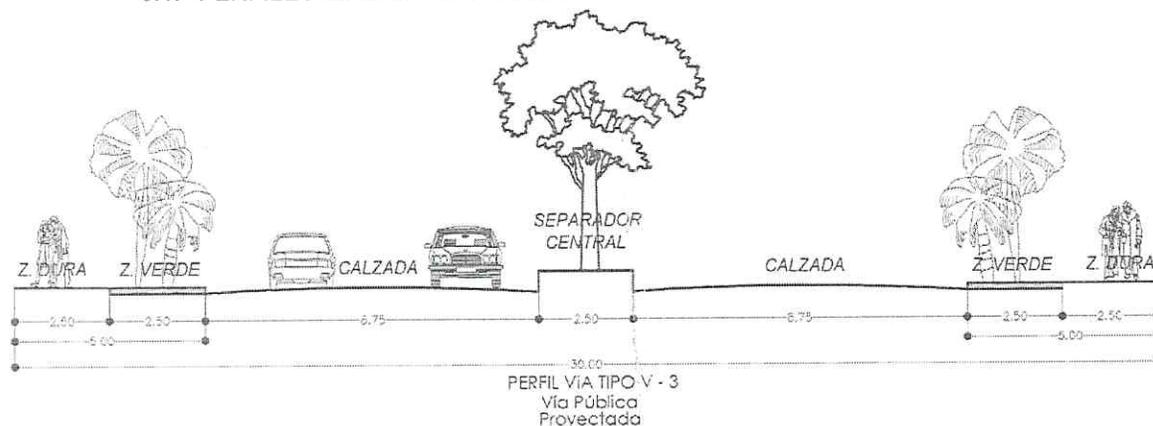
Perfil vial propuesto VIA PÚBLICA AV. PRADILLA.
